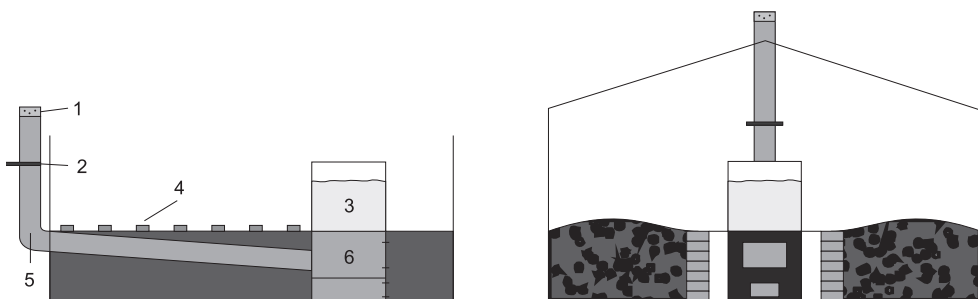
Отопление заглубленной печью: 1 — искрогаситель; 2 — загвижка; 3 — емкость для воды; 4 — решетчатый пол; 5 — дымоход; 6 — топка
